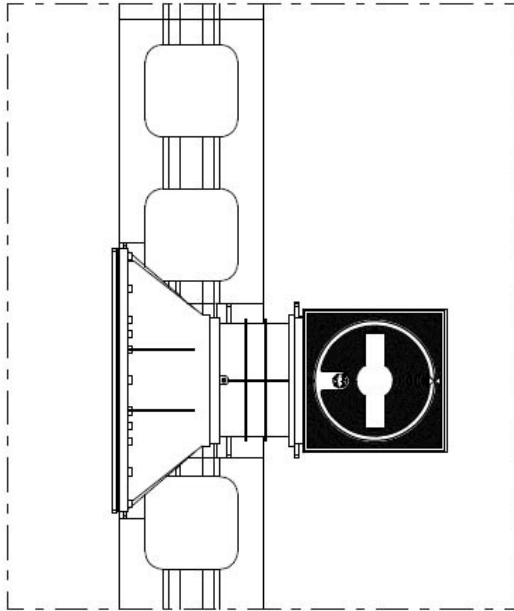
Implantation skimmer (coupe horizontale d'une paroi)
